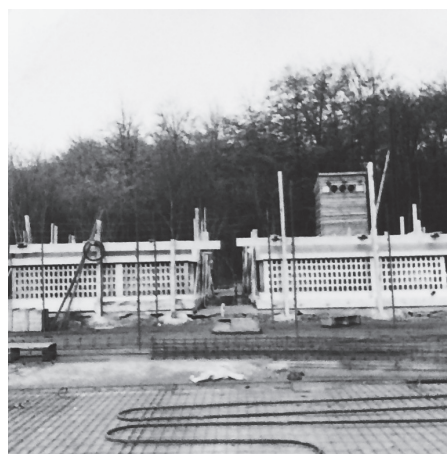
Préparation de l'armature d'une dalle avec le serpentin de chauffage. En arrière plan, des éléments de claustra.
